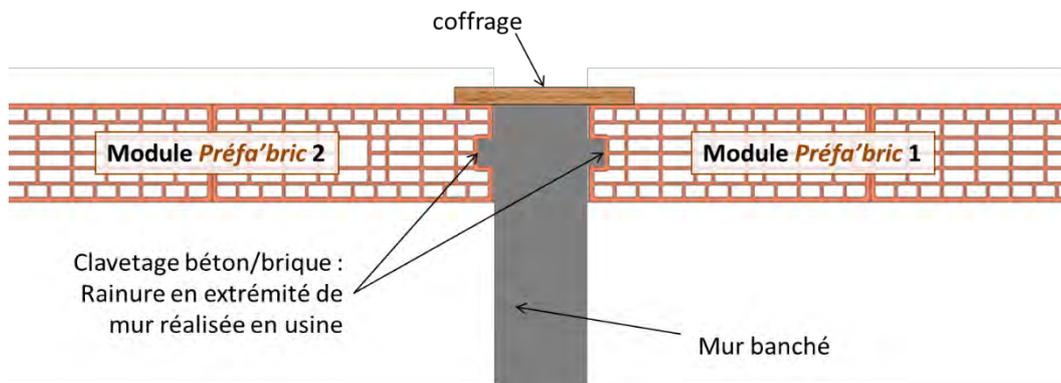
JONCTION DE FAÇADE AVEC UN MUR DE REFEND
